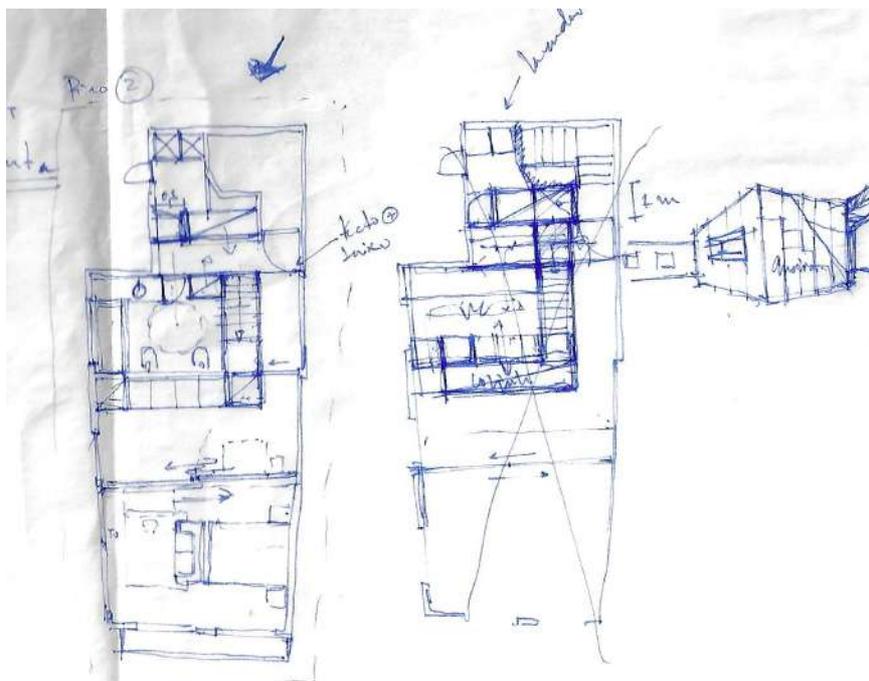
Croqui Arquiteto Filipe Vilas Boas
